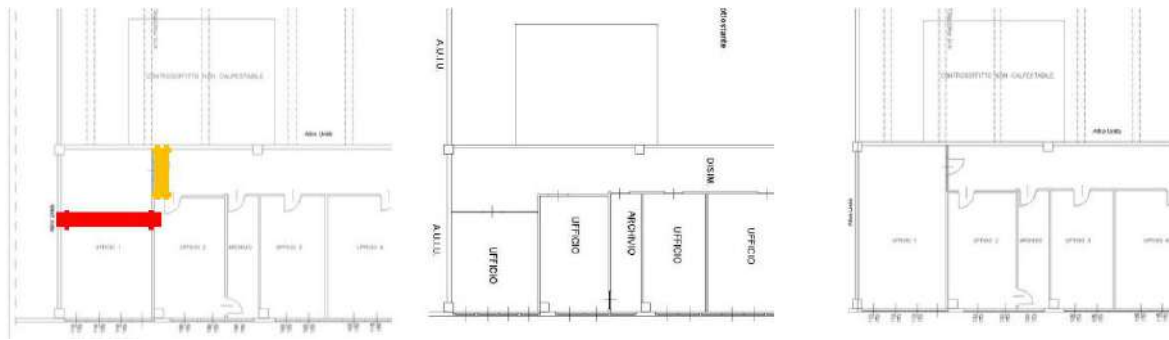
planimetria catastale Fig. 16: planimetria depositata in Comune
